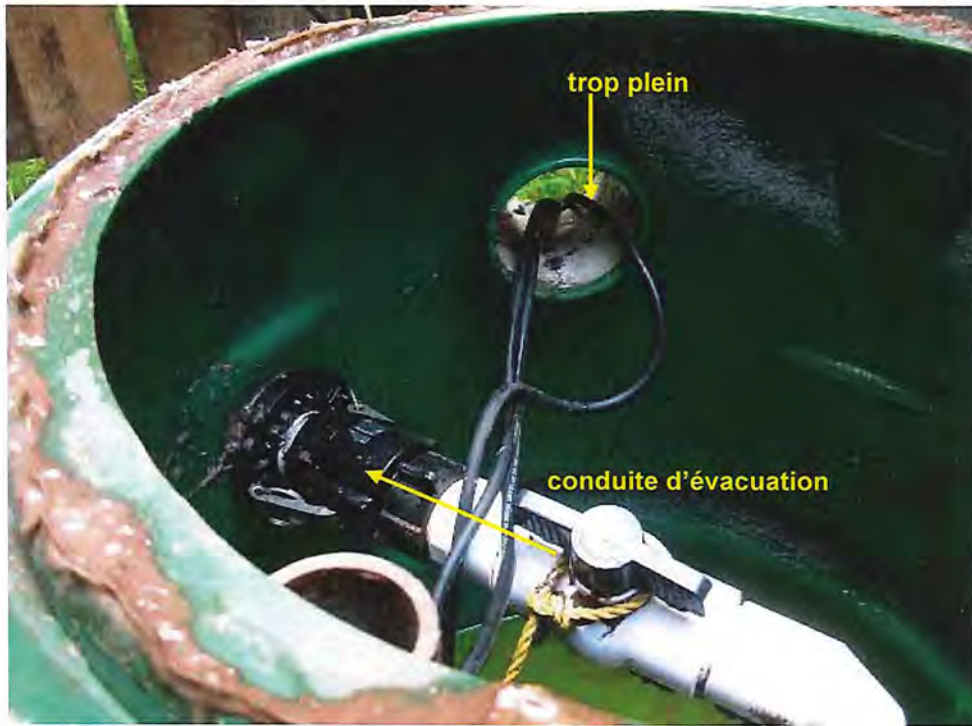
Station de pompage 1A située au sud du site 517 – traces de débordement
